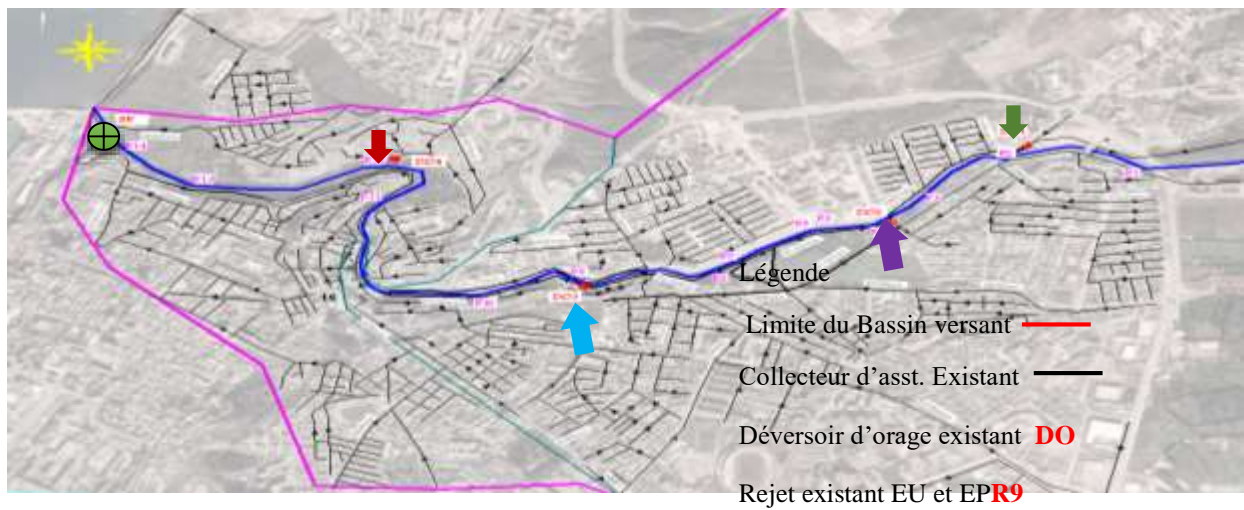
Ouvrages D'ASSAINISSEMENT Existants sur les deux RIVES DE L'OUED AIN SEFRA
